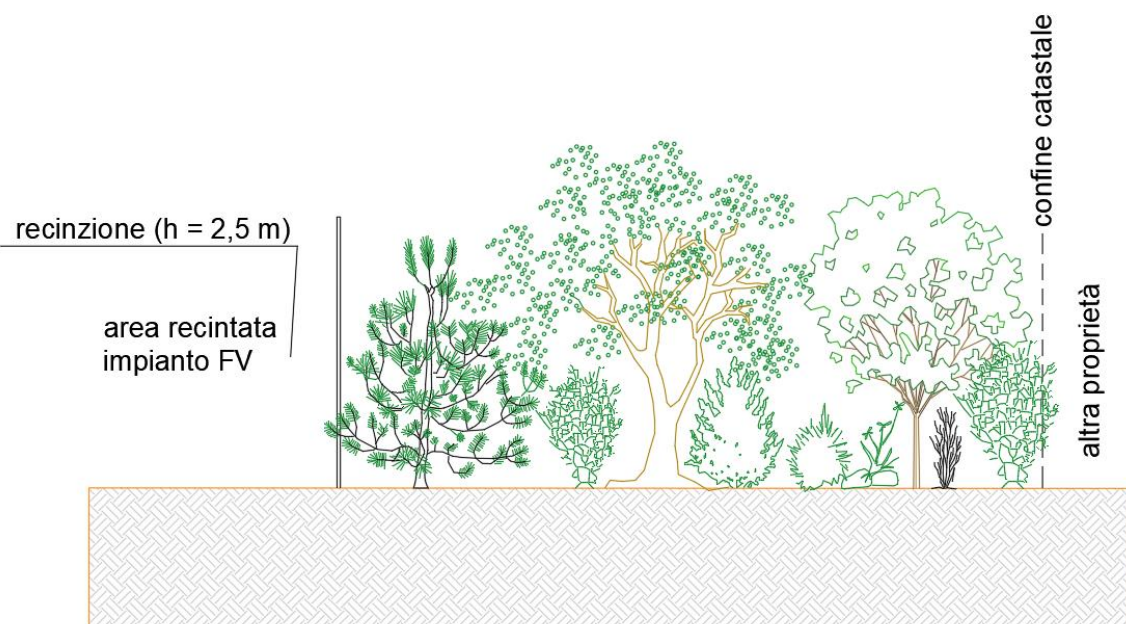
Stralcio sezione della siepe (area perimetrale dell'impianto)
